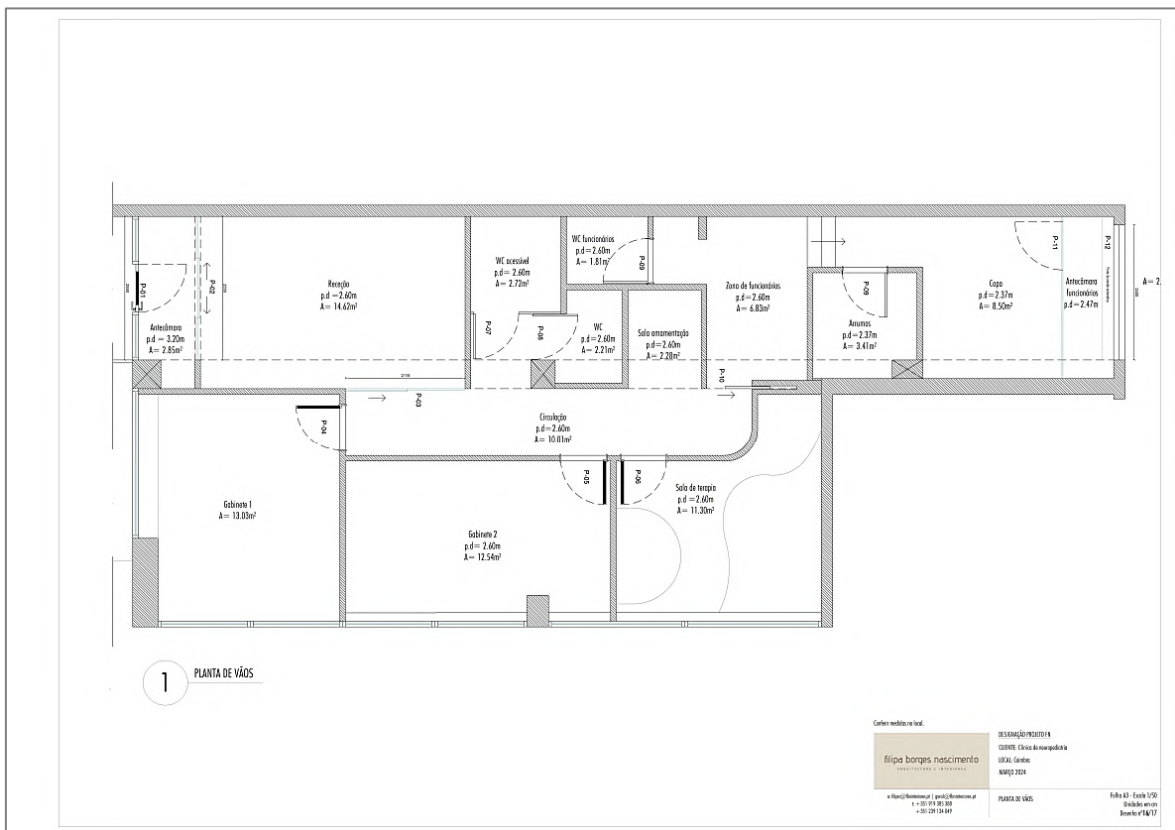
Planta de vãos - Projeto CNP. Fonte: Equipa FBN.
